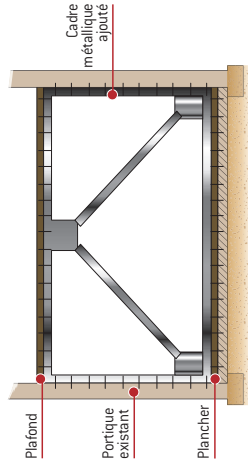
Exemple de renforcement du contreventement par ajout de croix type K ou Saint-André en charpente métallique ou en poutre de béton armé à un portique existant (coupe transversale)
